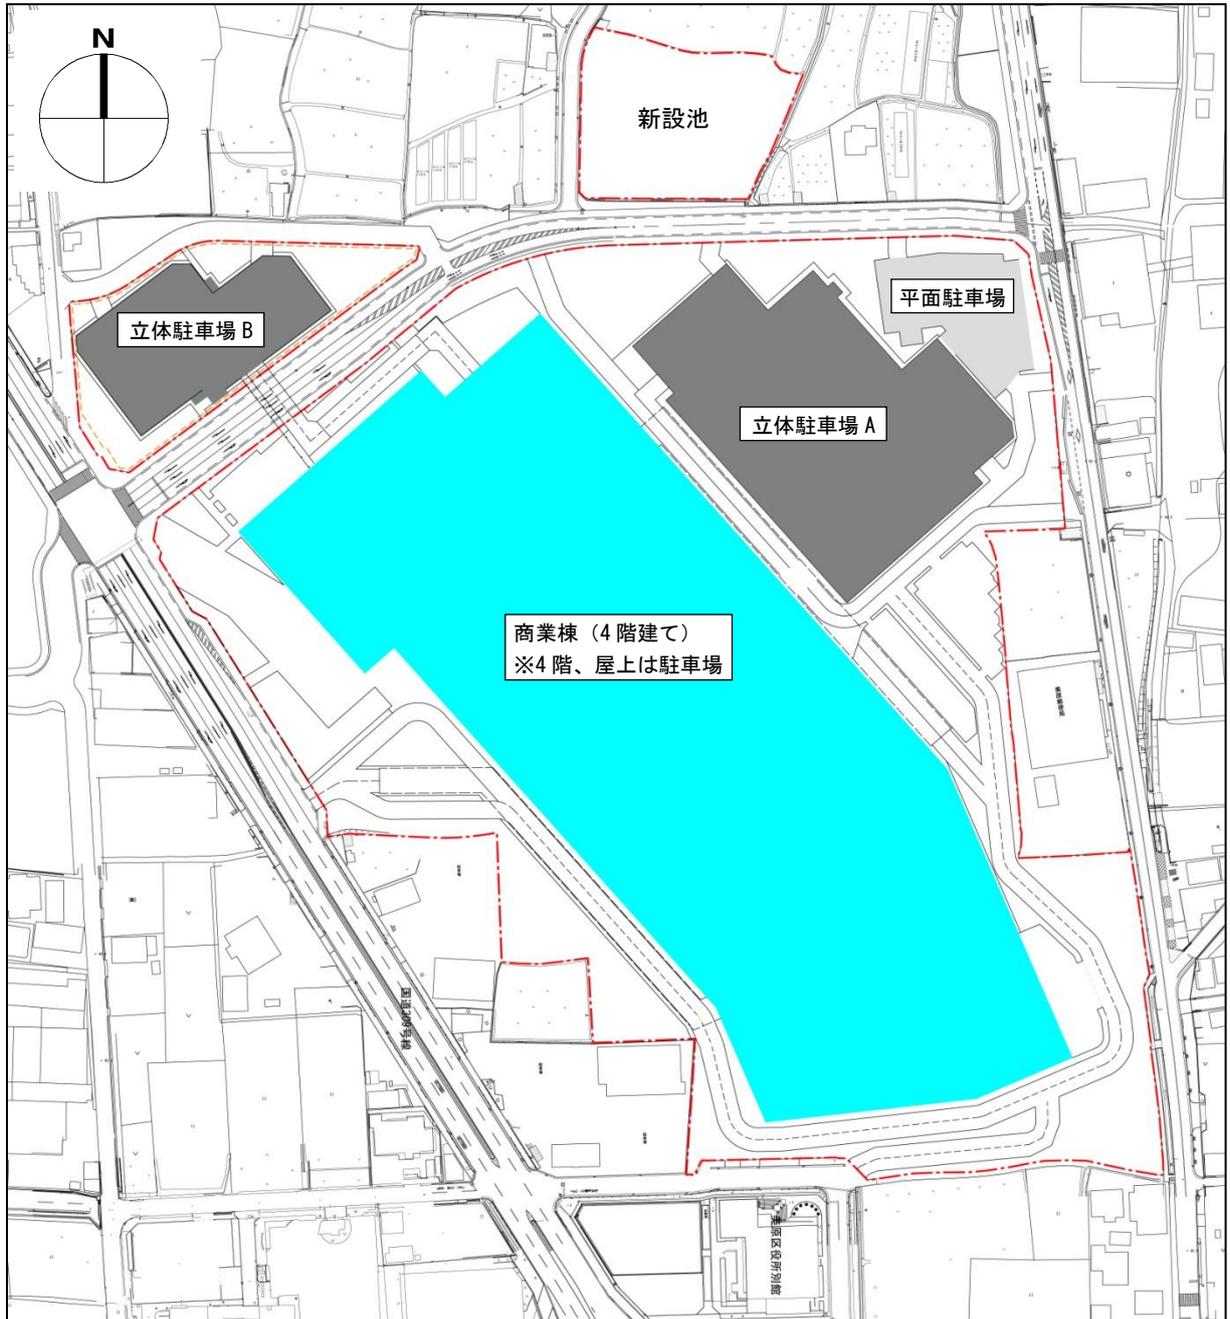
(1) 施設配置計画案 1 (平面図) (配慮計画書から引用)
